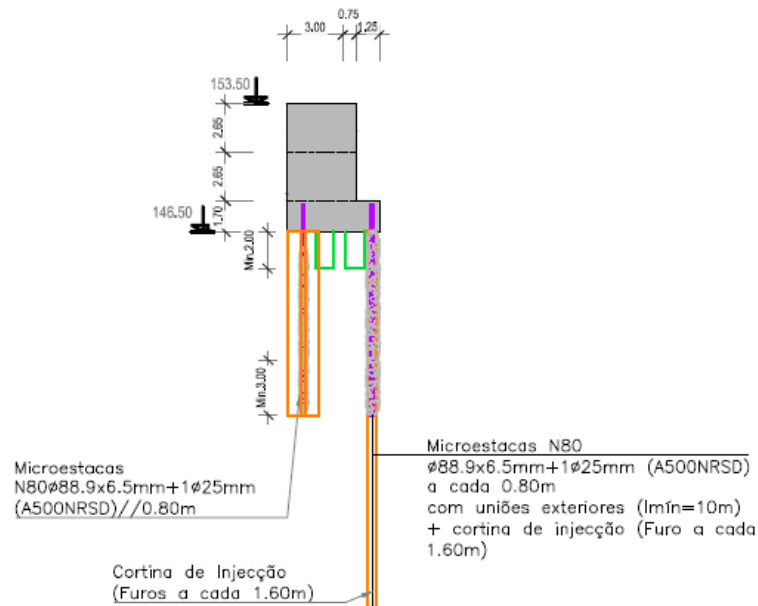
Secção transversal do muro de betão simples da solução executada para a secção do Corte 10 (adaptada de Pinto et al., (2014)).
